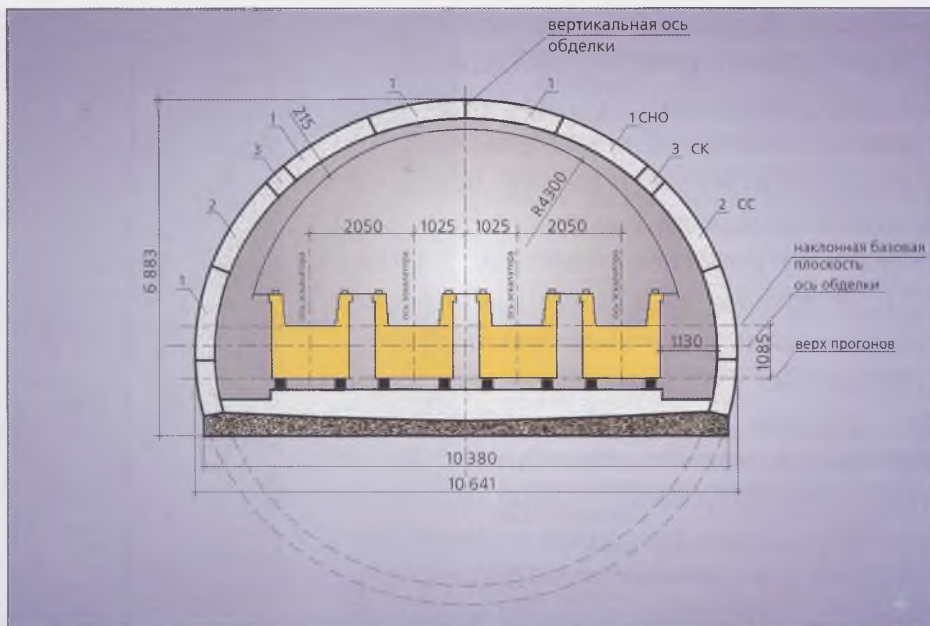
Поперечное сечение эскалаторного тоннеля без вентканала для вентиляции станции
